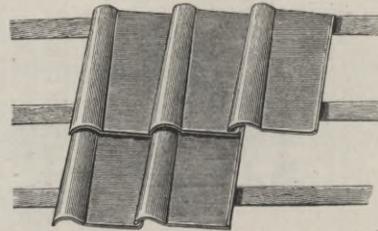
Krempziegel. (H. Bolze & Co., Maschinenfabrik und Eisengießerei in Braunschweig.)
